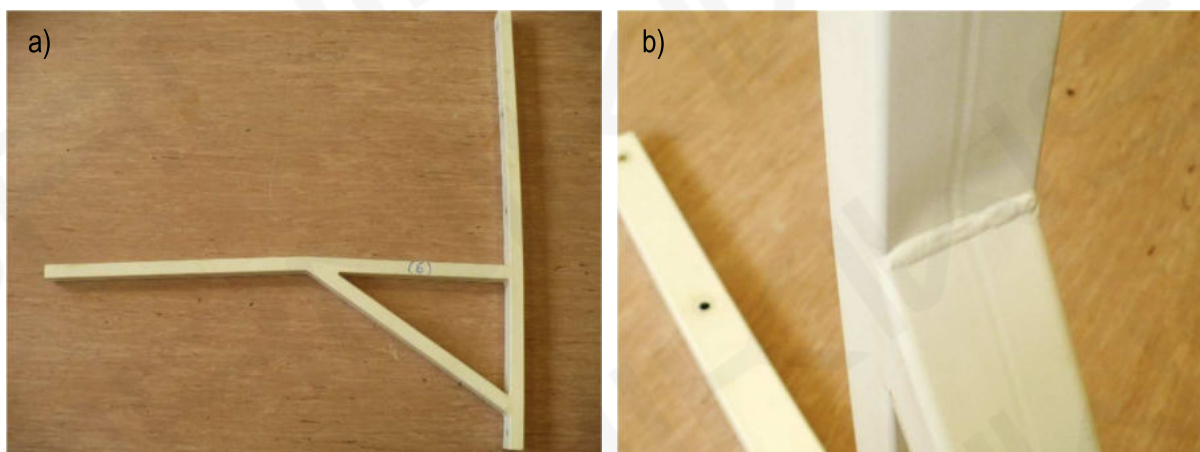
Widok zniszczonego elementu P3: a) widok ogólny, b) miejsce zniszczenia
